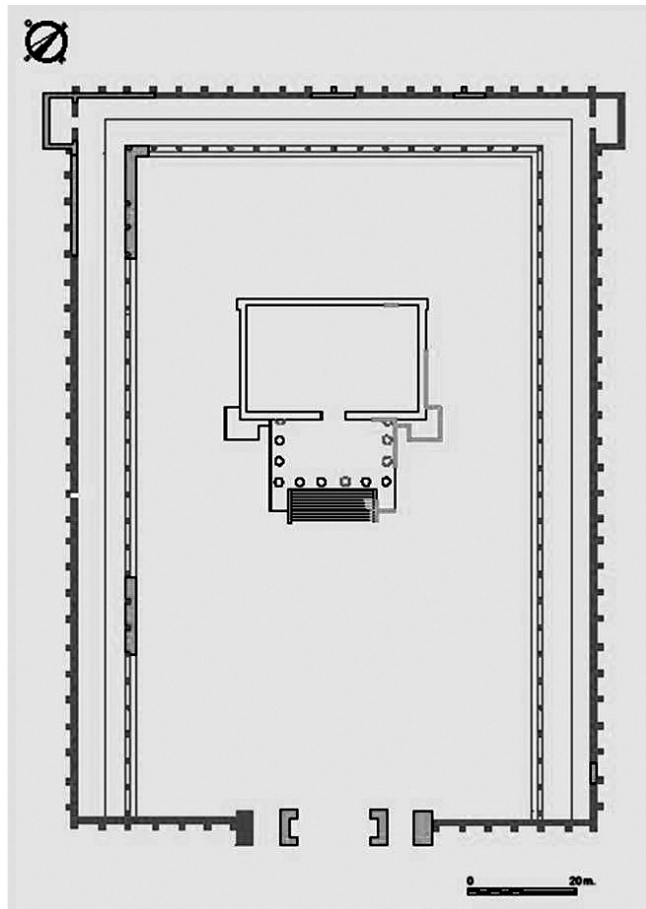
Planta reconstruida del Conjunto Provincial de Culto Imperial de *Augusta Emerita*.
